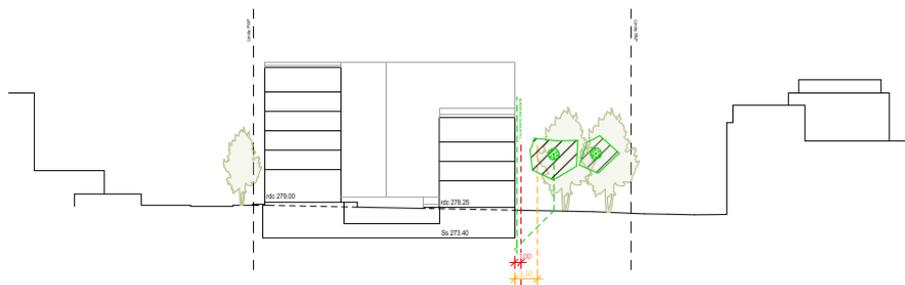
Coupe et plan - arbres existants (Présentation Christian Bauer & Associés Architectes S.A.)
